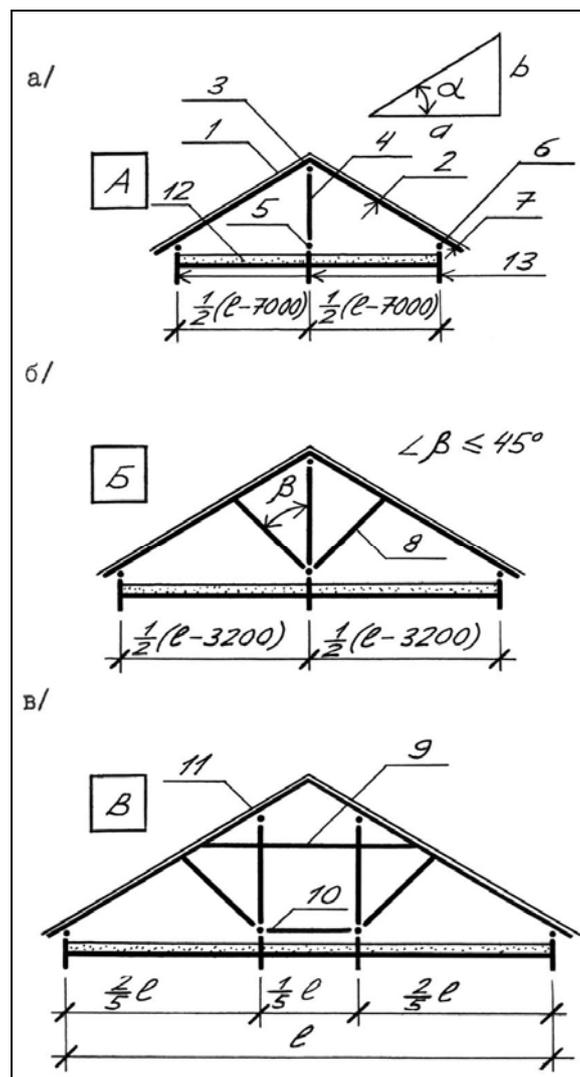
Схемы поперечных разрезов крыши: а – схема А, б – схема Б, в – схема В;
